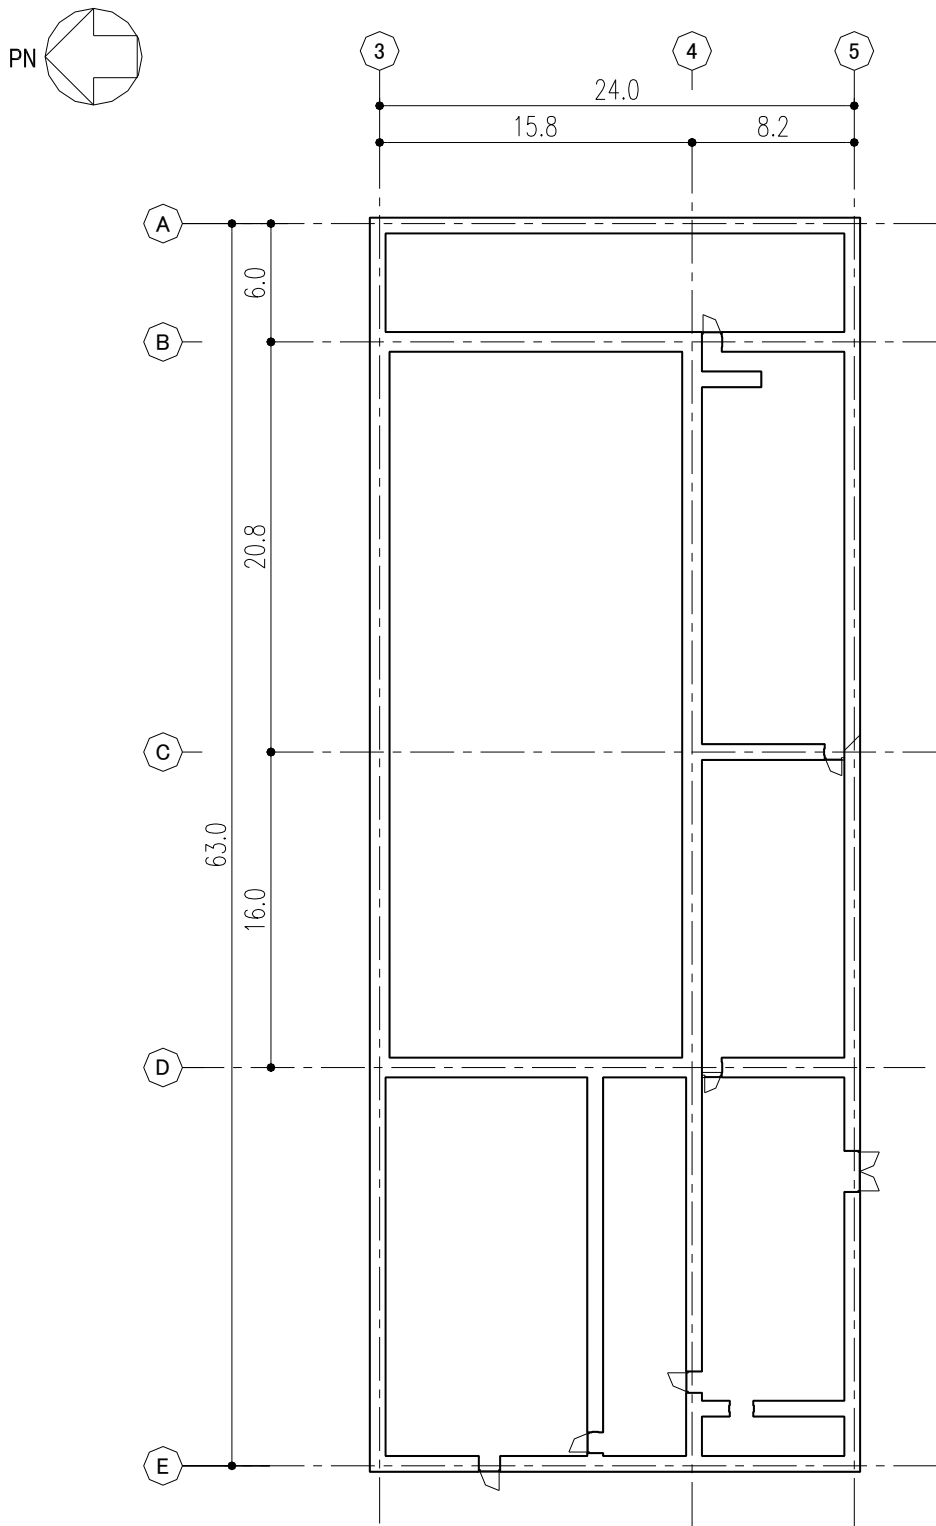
スラッジ棟 建屋平面図 (設計 G.L. +0.2) (単位 : m)
